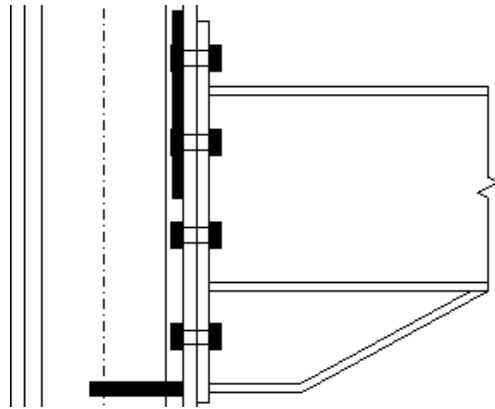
Esquema Conexión Simple Apoyada Tijera y Columna
